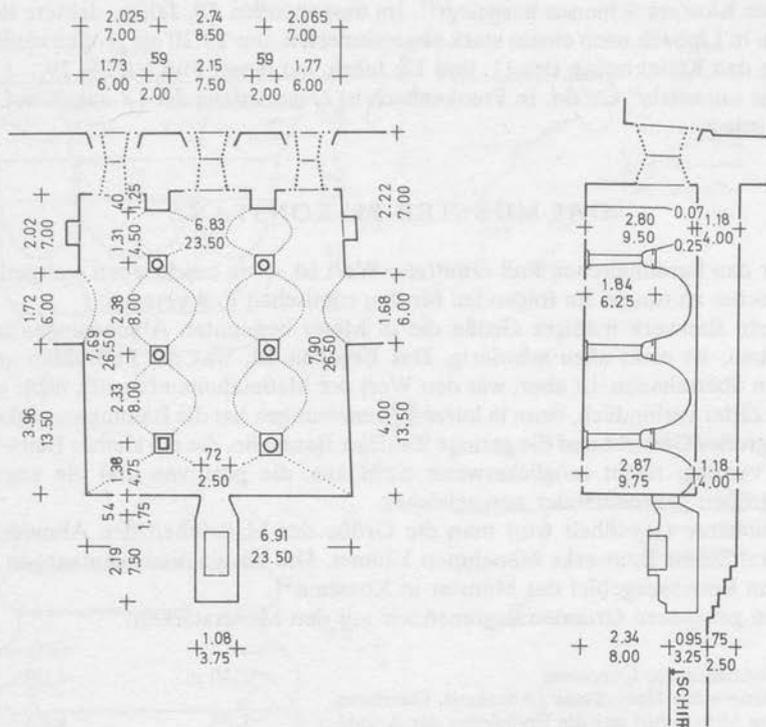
Konstanz Münster, Krypta*. Grundriß und Längsschnitt 1:200
